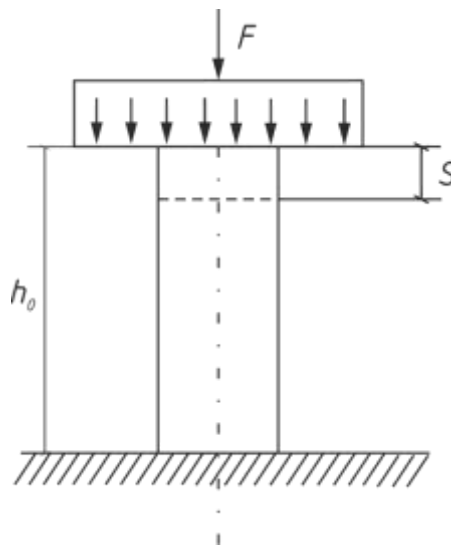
Схема испытаний грунтов методом одноосного сжатия [3]
